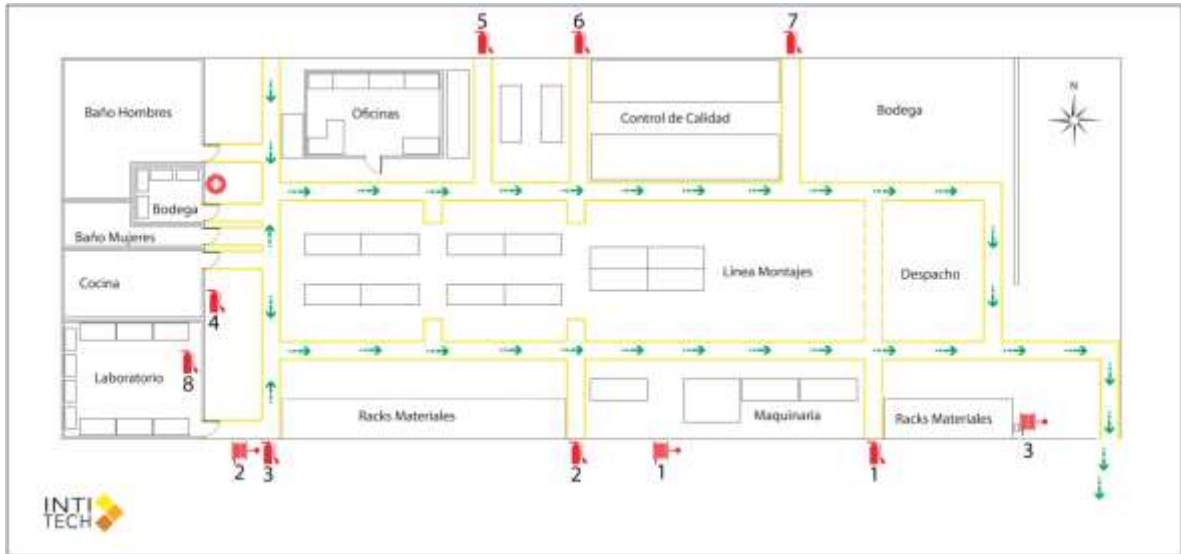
Layout de la Planta Inti-Tech (Elaboración Propia)
